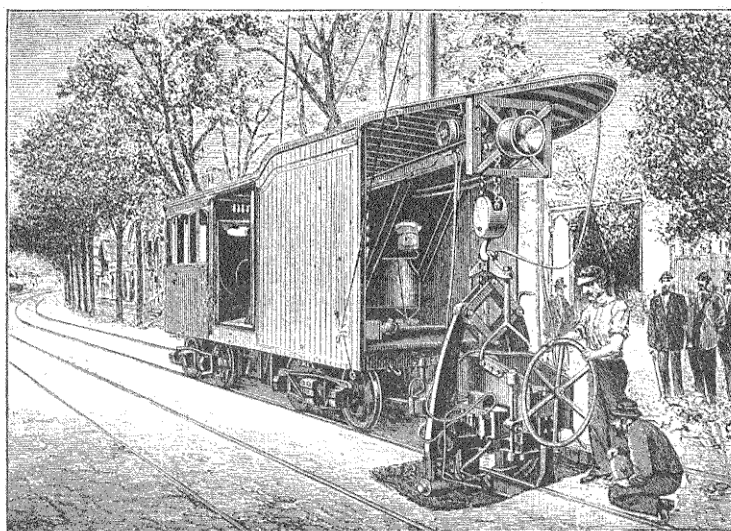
Voiture équipée pour la soudure électrique des rails.
